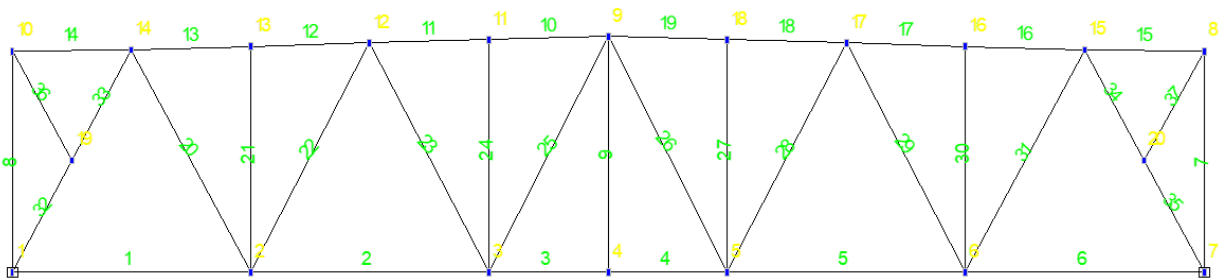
Розрахункова схема ферми в SCAD
